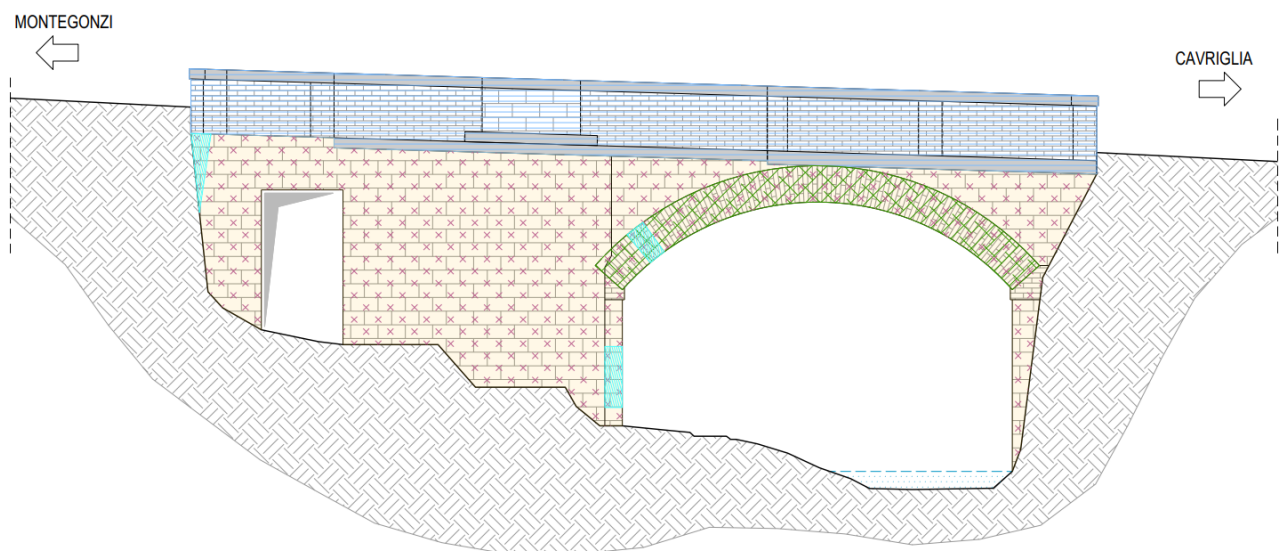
Stato di Progetto - Interventi di consolidamento – Prospetto est
